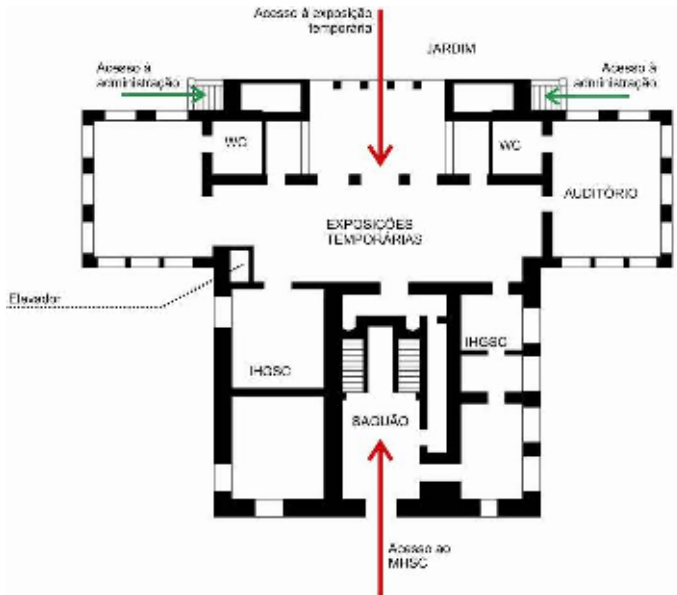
Acessos ao museu pelo pavimento térreo. Fonte: Autora (2009).
